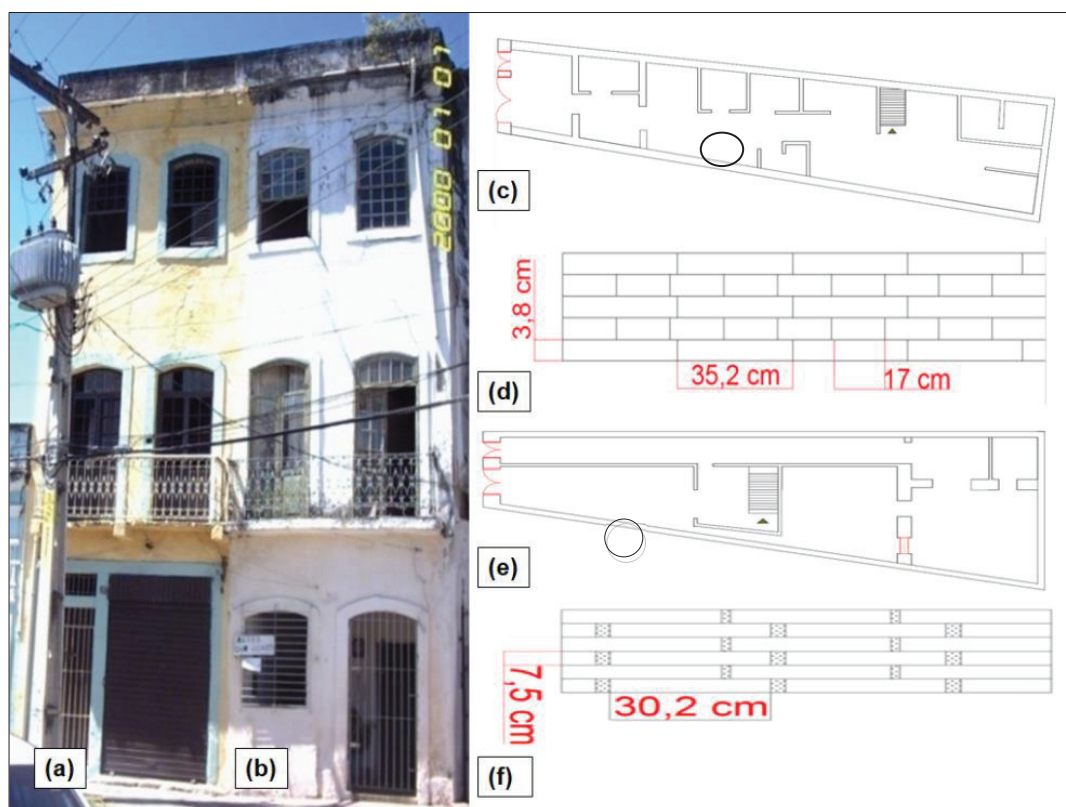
Unidade de moradia 02 e 03:(a) Rua da Glória, N°187e (b) N°189; (c) Planta baixa do pavimento térreo de coleta da unidade 02; (d) Paginação da área de coleta da unidade 02; (e) Planta baixa do pavimento térreo de coleta da unidade 03; (d) Paginação da área de coleta da unidade 03. Fonte: DPPC – Recife, 2000
